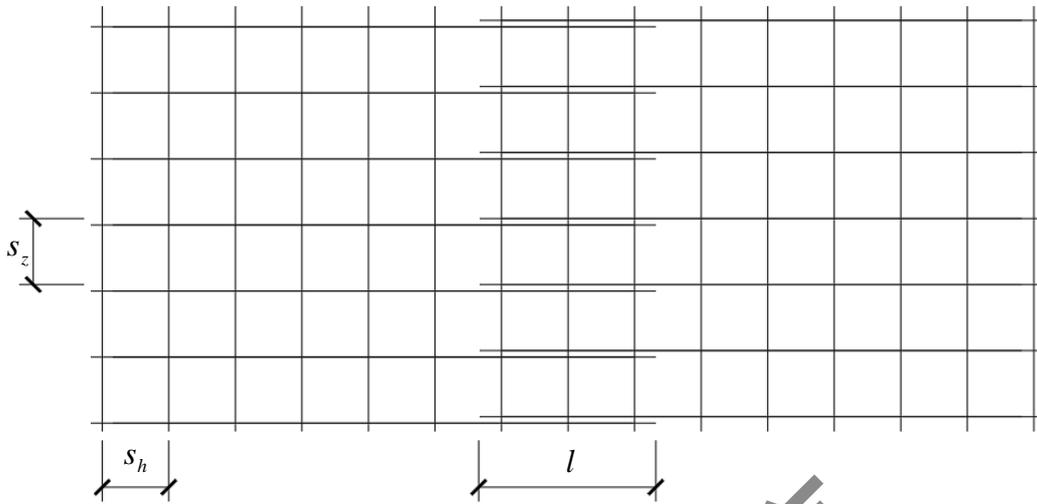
GFRP 筋混凝土铺装层筋材布置与搭接长度示意图
